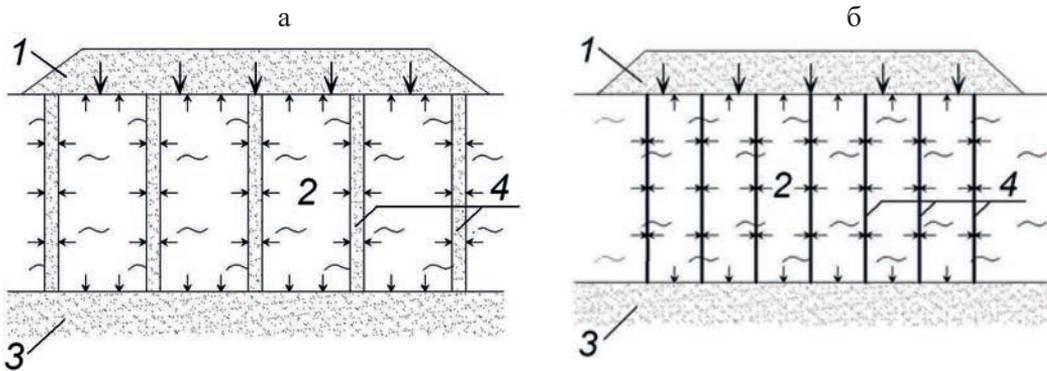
Принципиальные схемы уплотнения слабых грунтов пригрузочной насыпью с вертикальными дренами: а — с песчаными дренами; б — с ленточными дренами; 1 – пригрузочная насыпь; 2 – слабый грунт; 3 – фильтрующий слой; 4 – дрена
